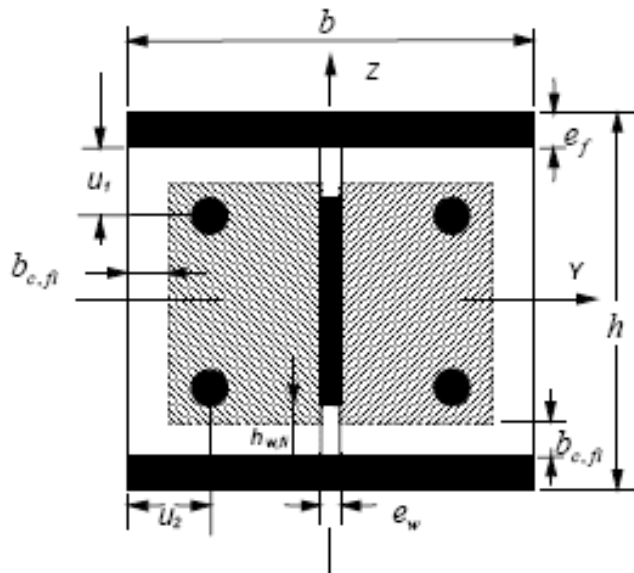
Section réduite pour le calcul de la résistance au feu d'un poteau mixte partiellement enrobé de béton
